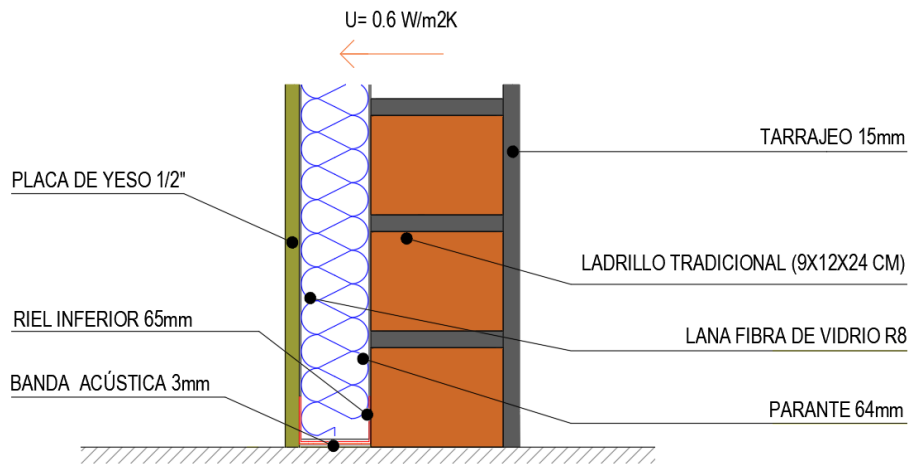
Detalle general para muro trasdosado de Drywall en perímetro de ladrillo.
